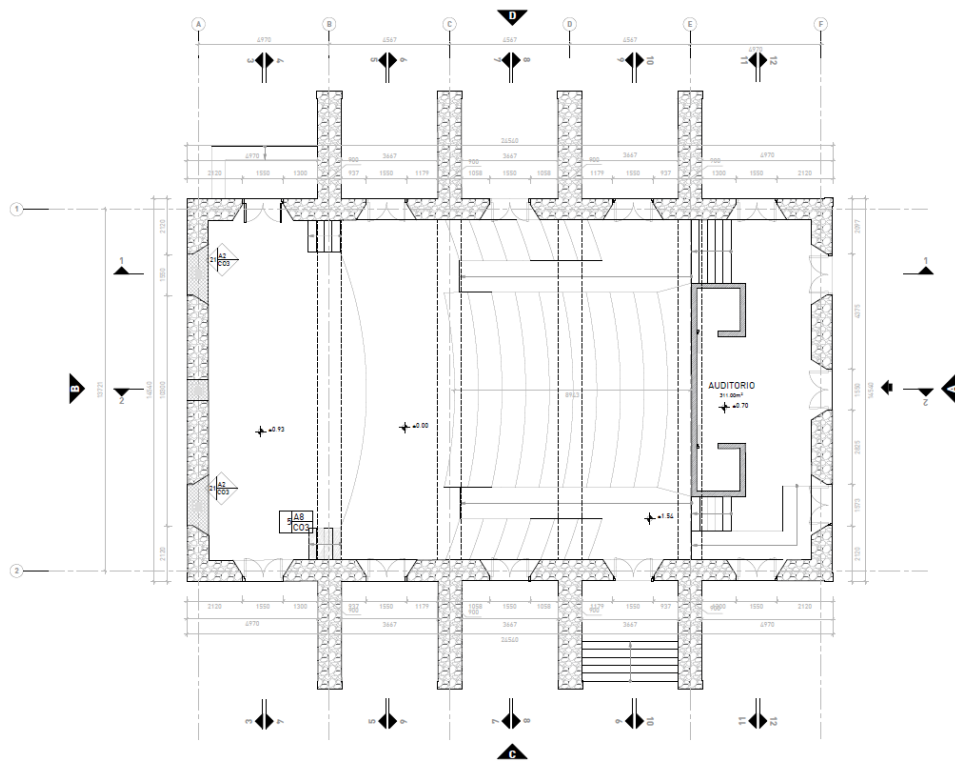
Identificación de deterioros en la planta principal del edificio correspondiente al Auditorio (Anexo 18). Fuente: Autora.
